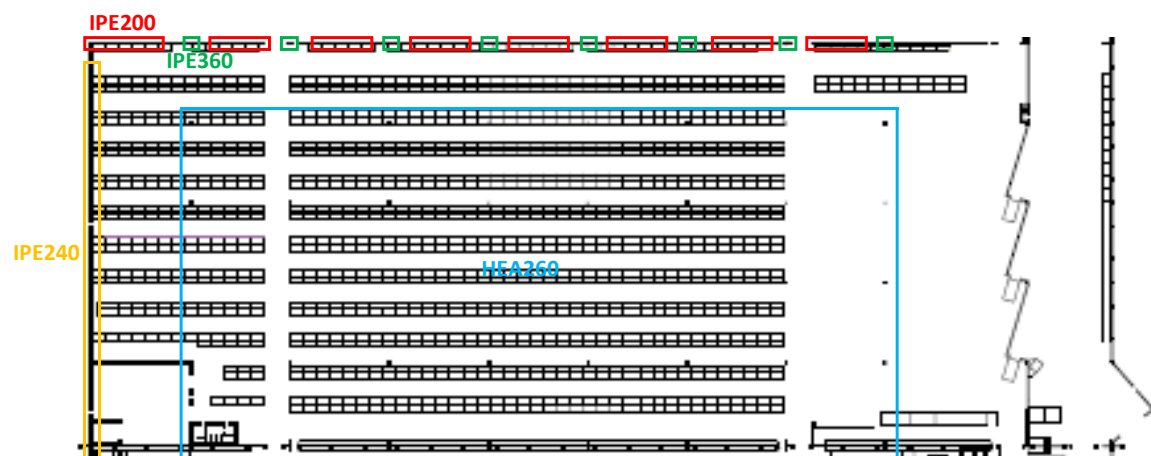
Position des poteaux et types de poteaux dans le bâtiment B
